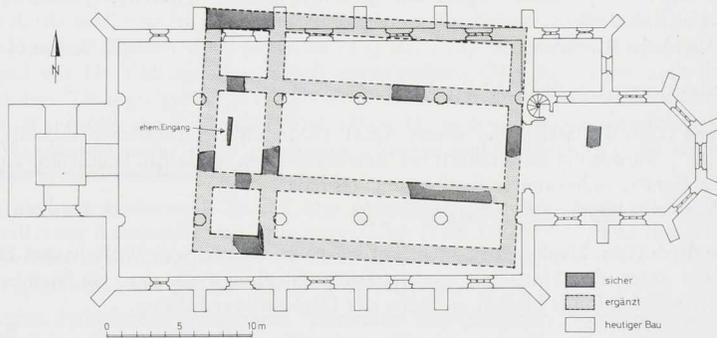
Weilheim an der Teck (Lkr. Nürtingen). Evangelische Pfarrkirche St. Peter; heutiger Grundriß mit Vorgängerbauten.
